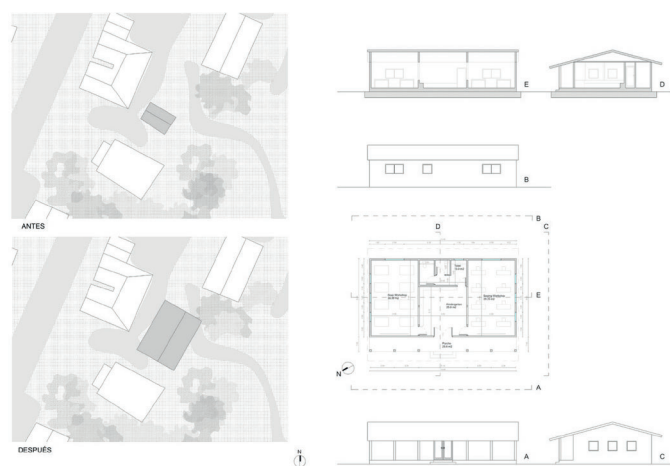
Planimetría de la ubicación y de la propuesta del Mother Workshop.
